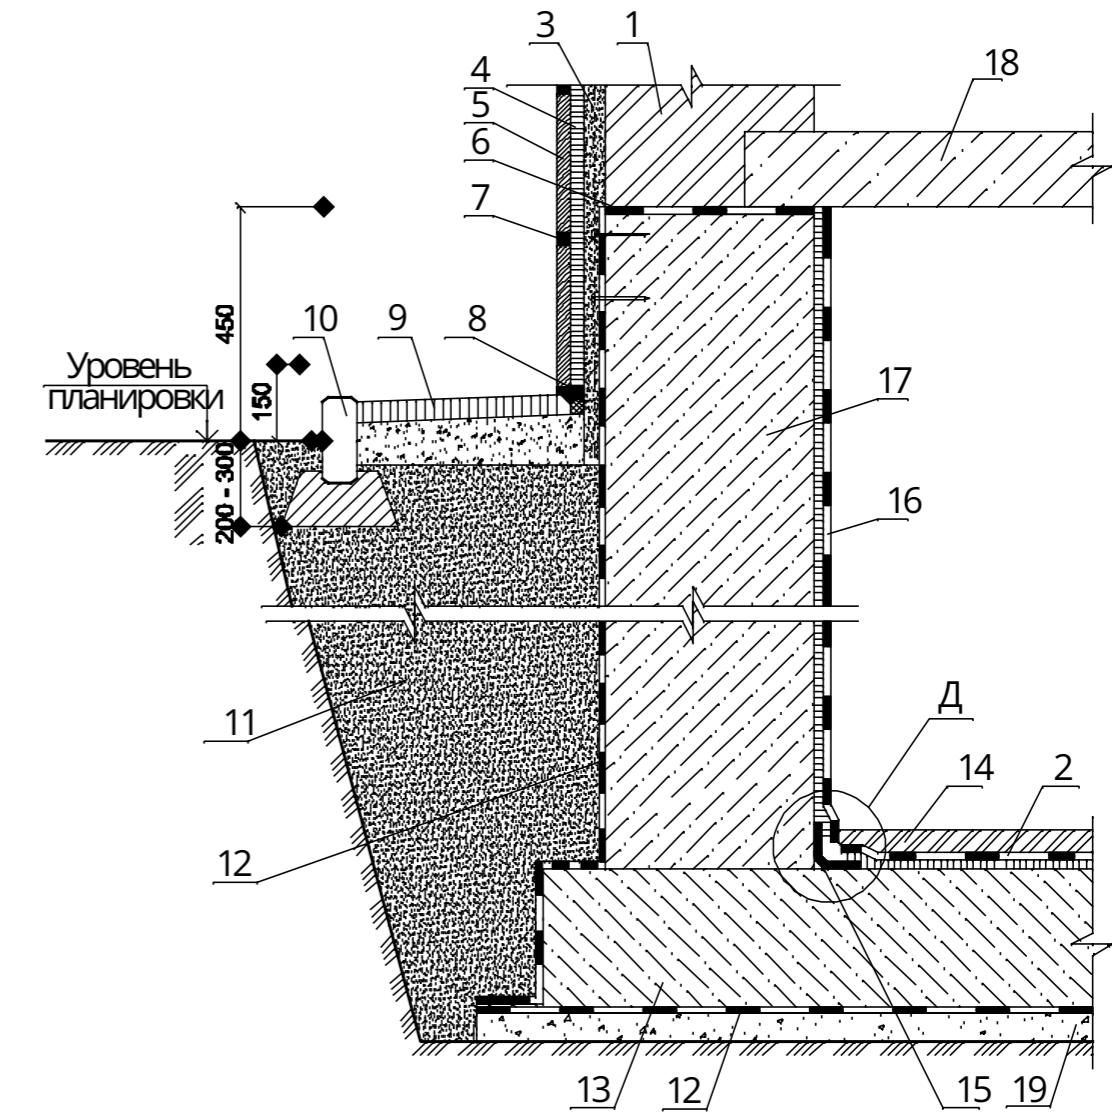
Узел 3. Гидроизоляция стены и фундаментной плиты с внутренней стороны подвала (ремонт)
